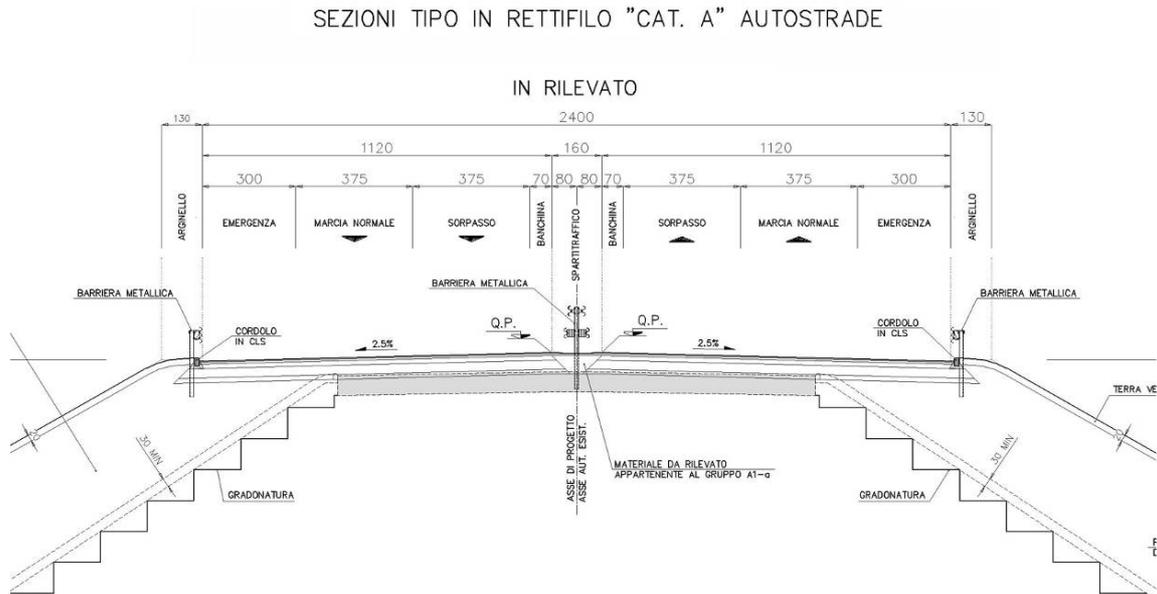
Sezione tipo di progetto (adeguamento simmetrico Variante SS1 Aurelia)
